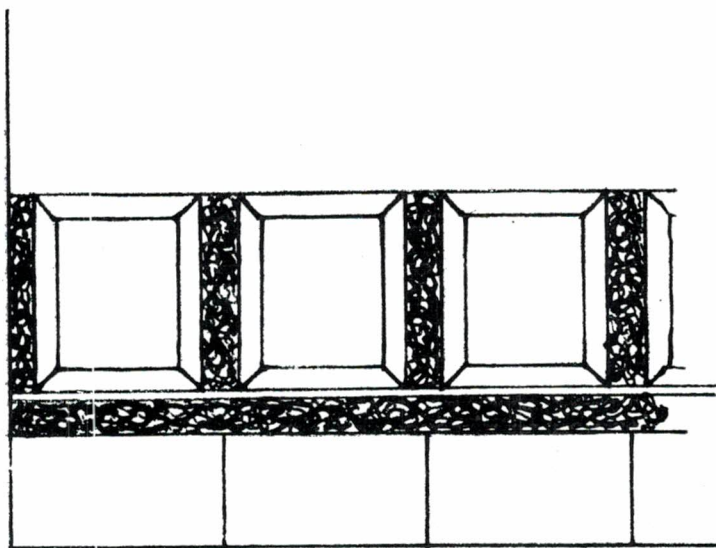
Ricostruzione dell'intonaco della stanza 8.
